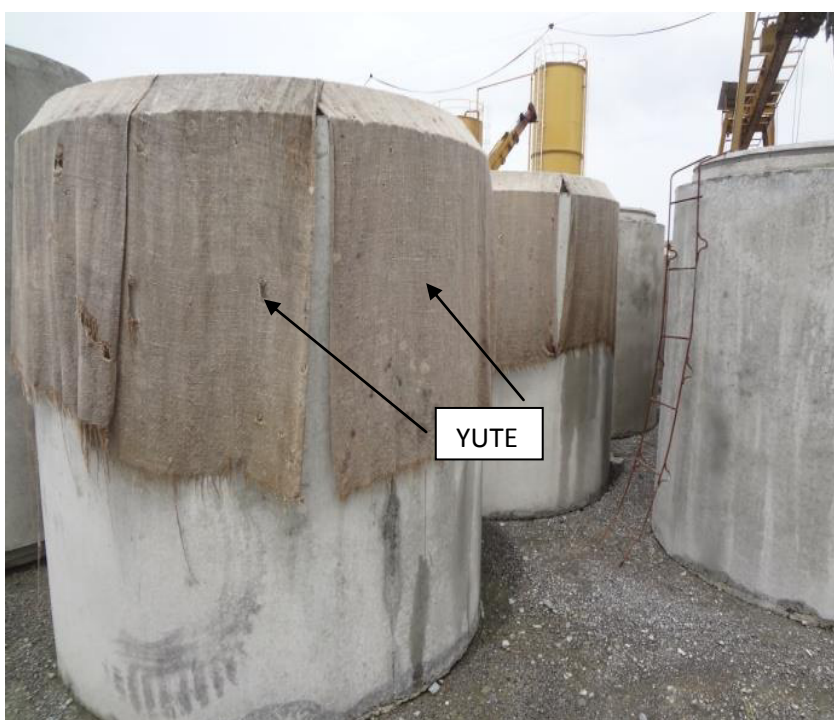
Proceso de curado de las tuberías de hormigón armado.
